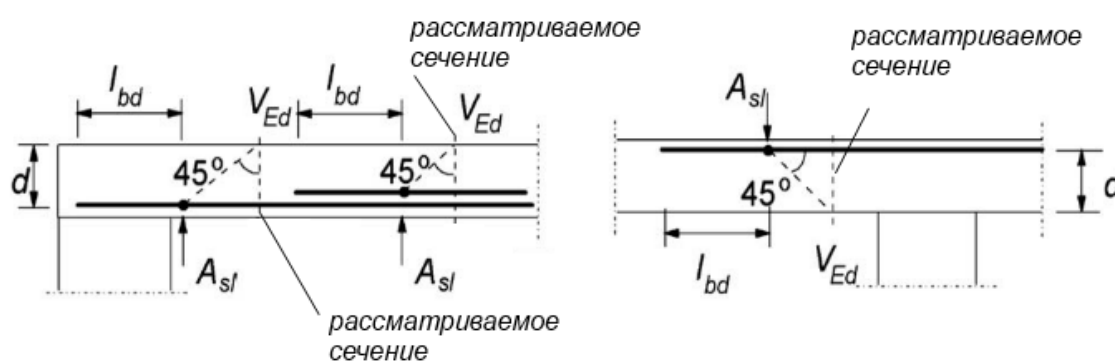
К определению площади растянутой арматуры A_{sl}
